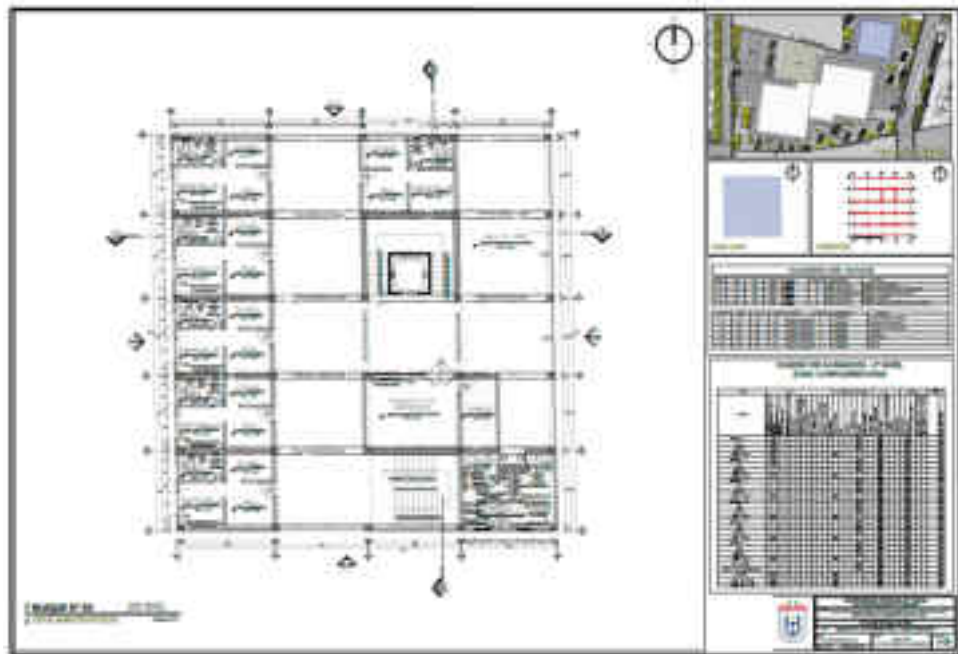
Planimetría del segundo nivel – bloque N° 03
